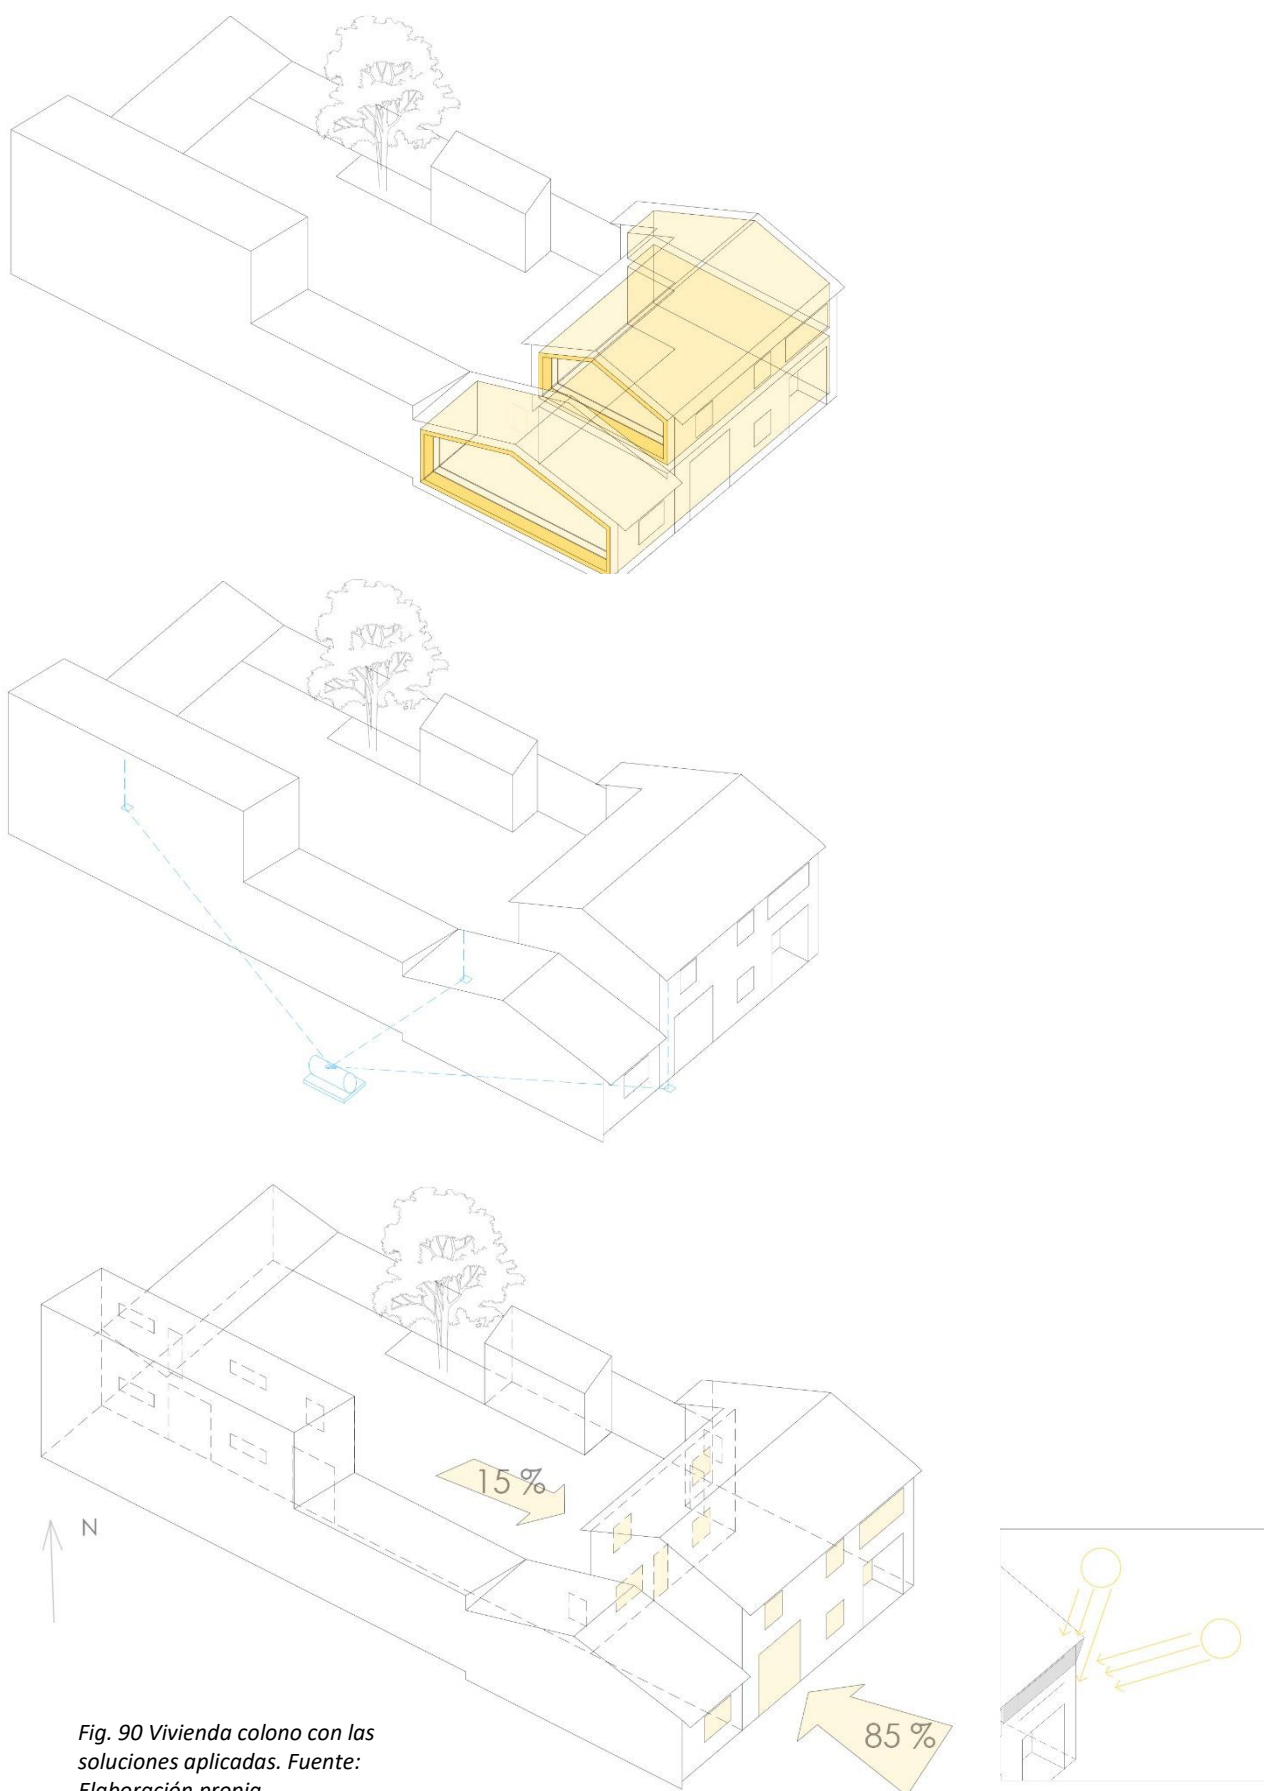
Vivienda colono con las soluciones aplicadas. Fuente: Elaboración propia
